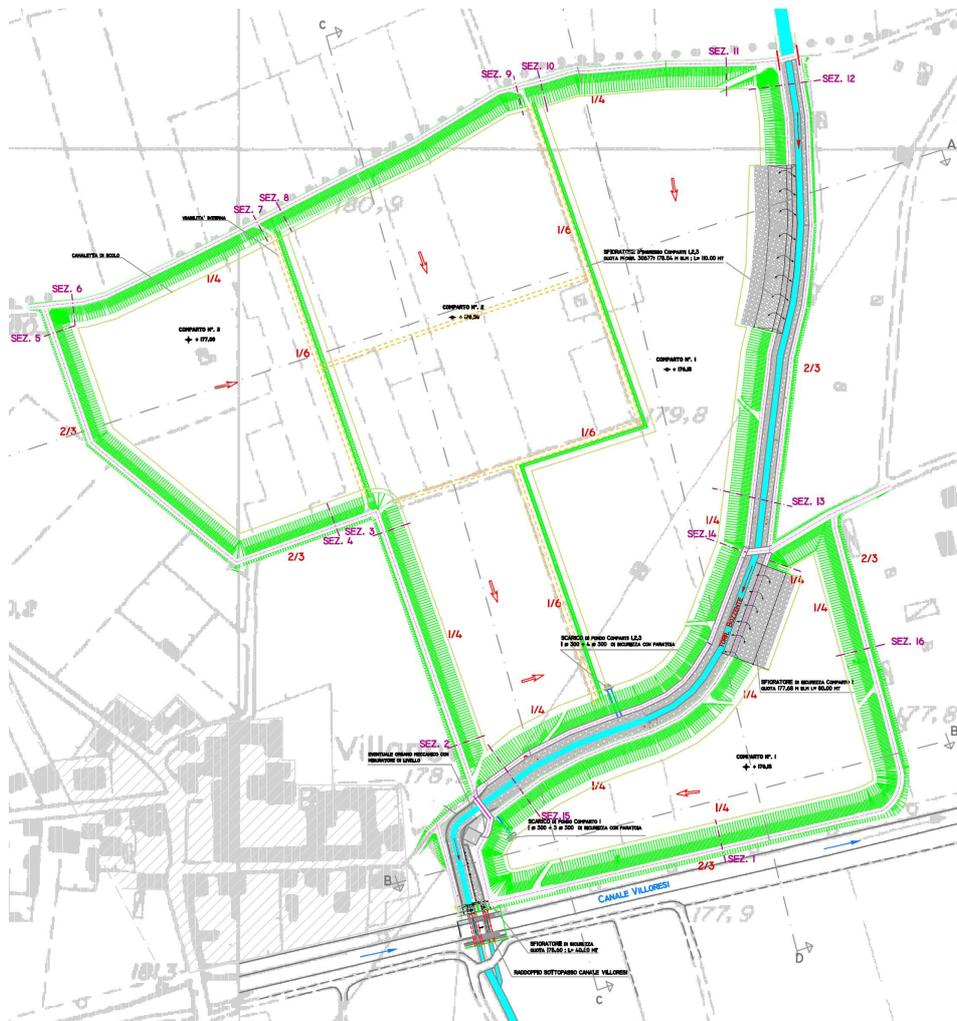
Planimetria dell'area di laminazione come da progetto definitivo marzo 2011
